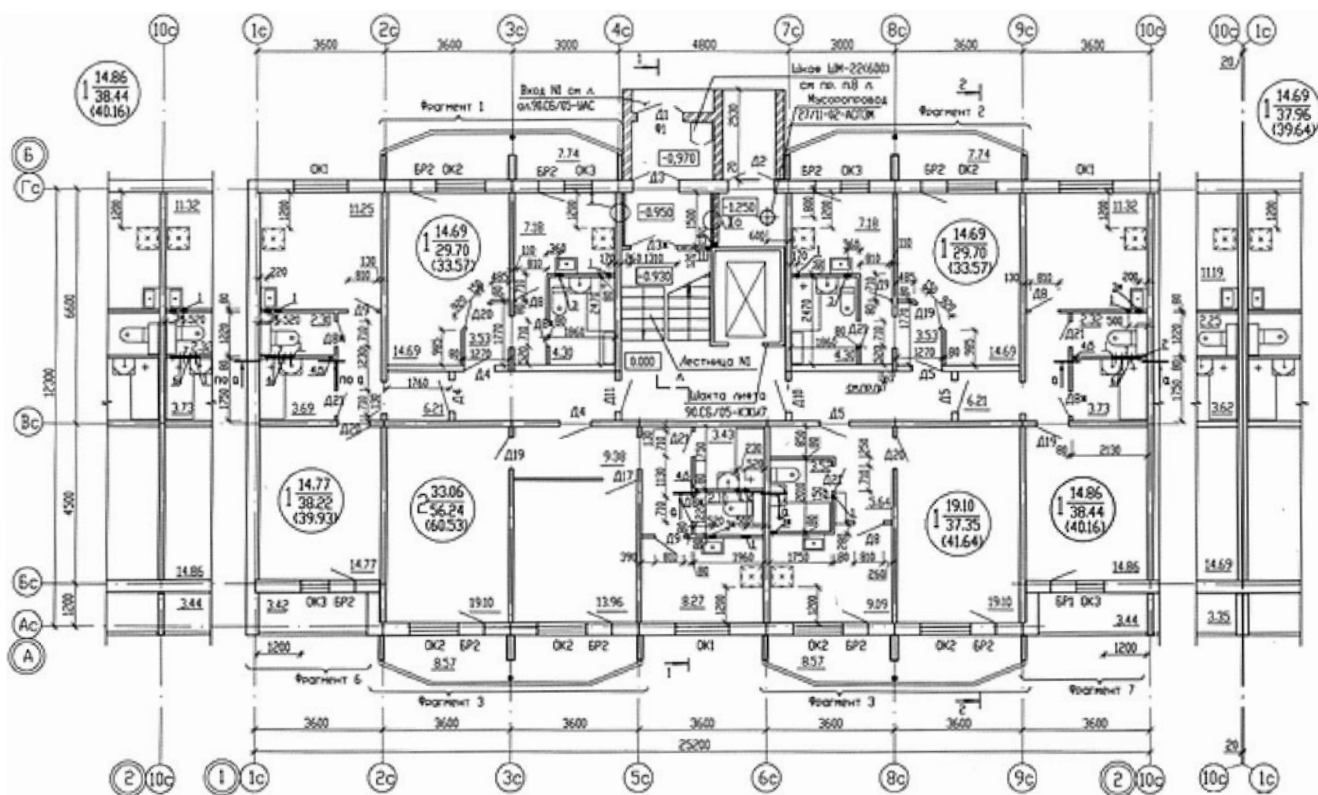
Планировочное решение 10-этажной 60-квартирной (рядовой) блок-секции
